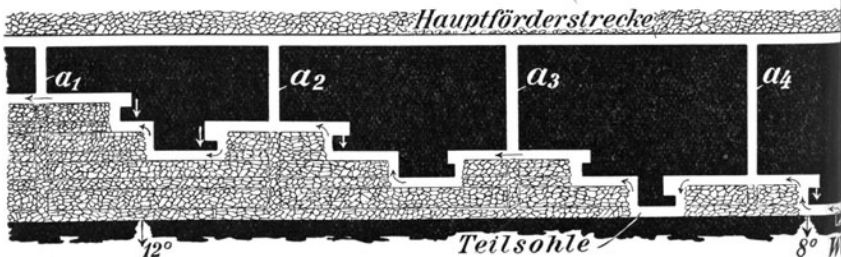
Stoßbau mit nur je einer Förderstrecke, in mehreren Nachbarabteilungen gleichzeitig betrieben (Unterwerksbau).
